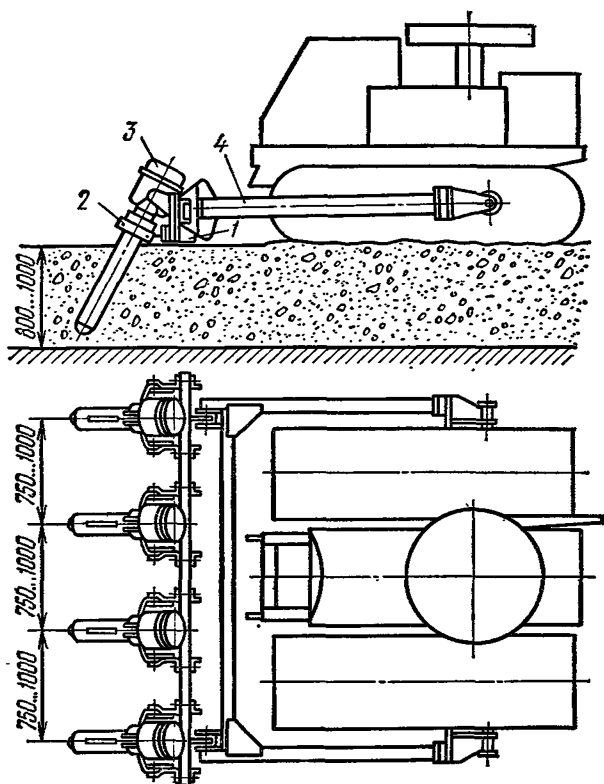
Малогабаритный электротрактор с навесным пакетом вибраторов ИВ-90:
